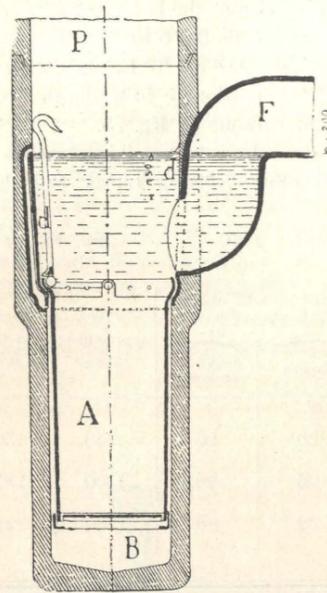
Pozzetto Geiger di Berlino (Sezione verticale).
